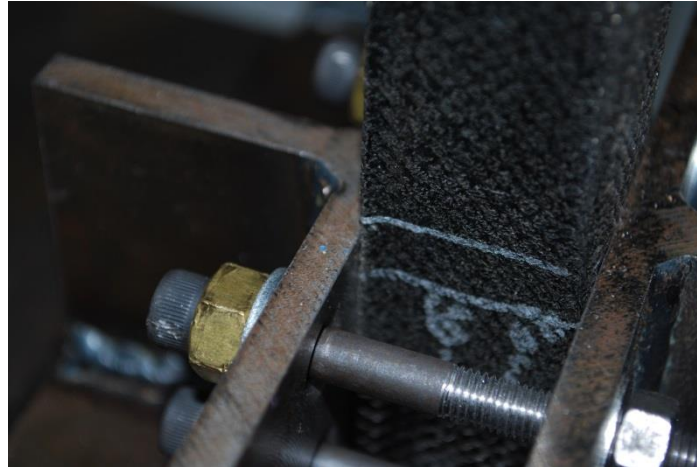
Arrête déformée de la poutre 1 lors du montage
